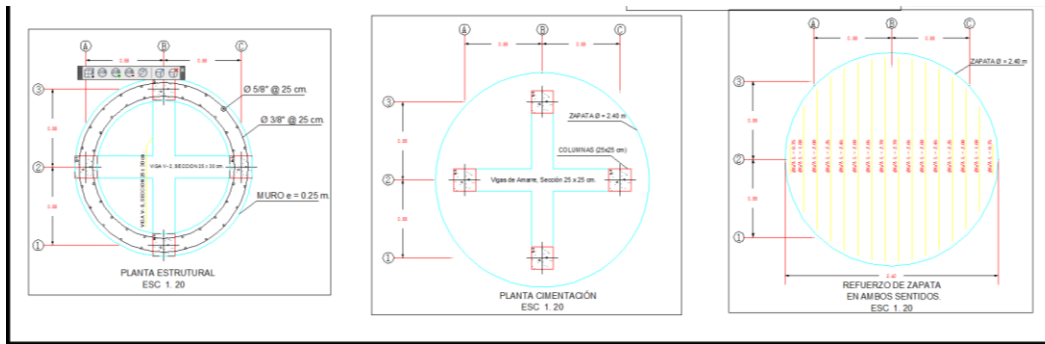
Planta estructural. Fuente ING Jaime Maestre Rodriguez
